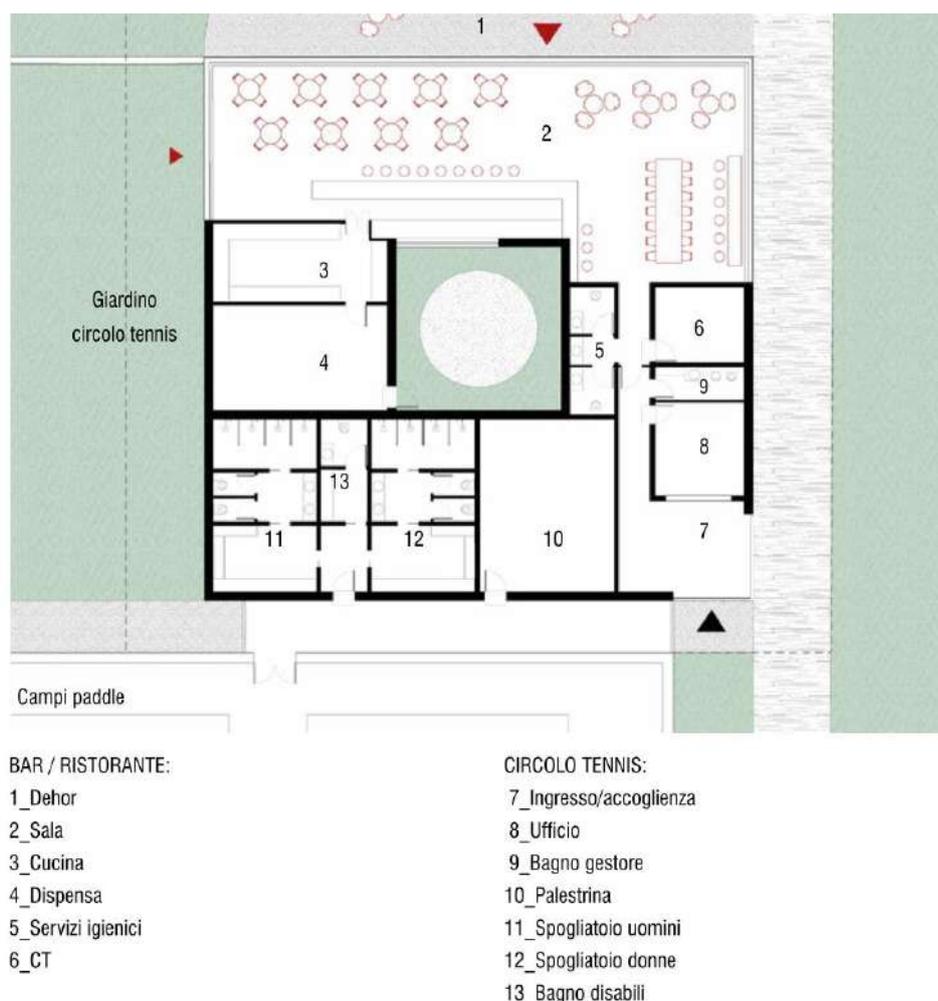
Planimetria di progetto Bar tennis – Arch. Roberto Rosset
